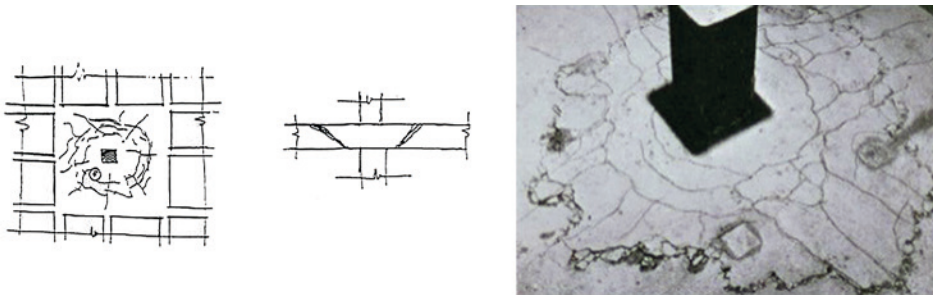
Esquema en planta y sección de una rotura por punzonamiento en torno a un pilar. La fotografía avala el esquema de la fractura en el plano superior del forjado.
